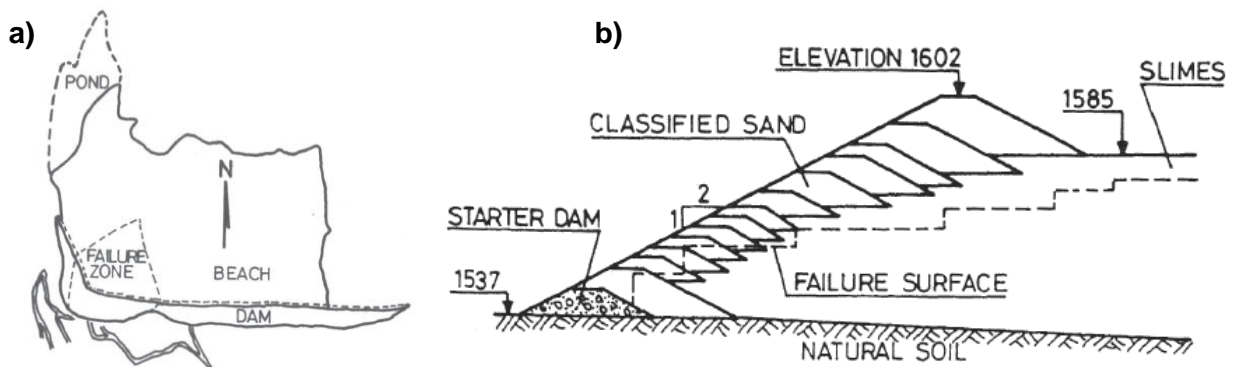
a) Vista en Planta previo a la falla y b) mecanismo de falla (Troncoso et al, 1993).
